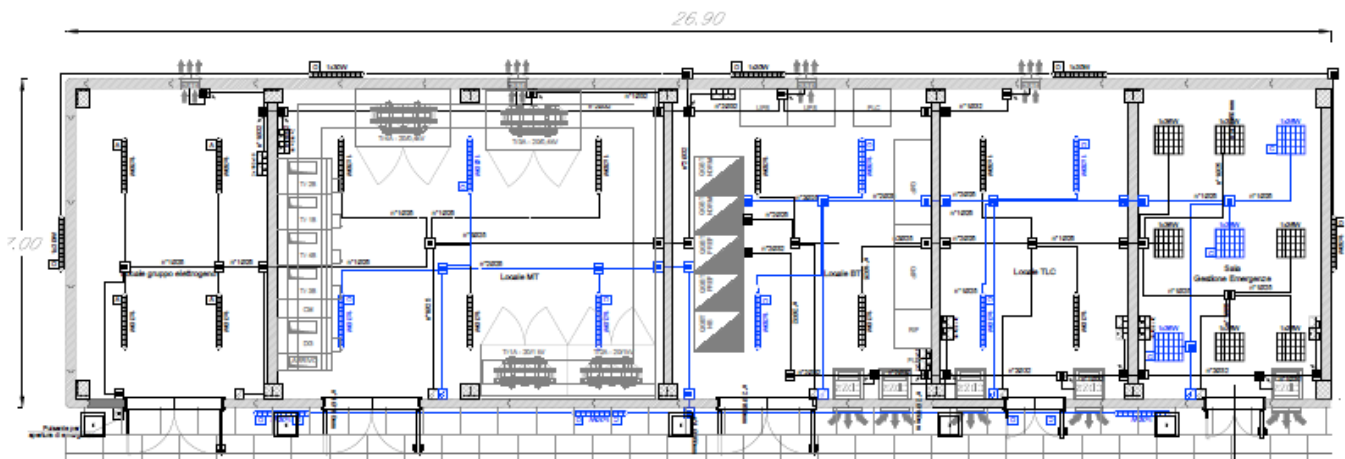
Pianta – Fabbricato tecnologico tipologico PGEP A2 (FA06)
